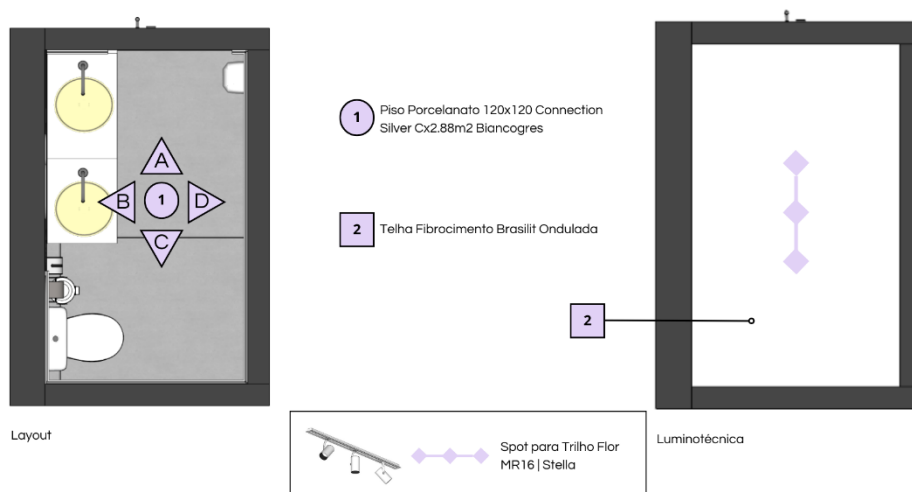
Planta de Localização: Banheiro Pôr do Sol
